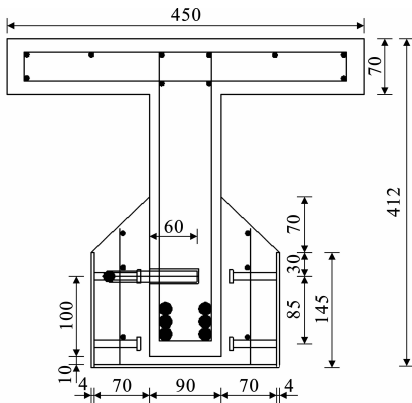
组合加固后钢筋混凝土T梁构造(单位:mm)
